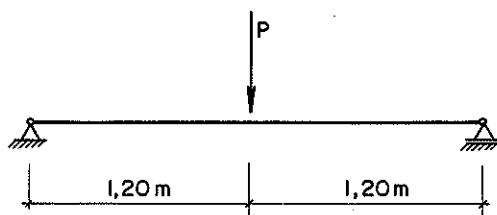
Ensaio de flexão das vigas principais do modelo
